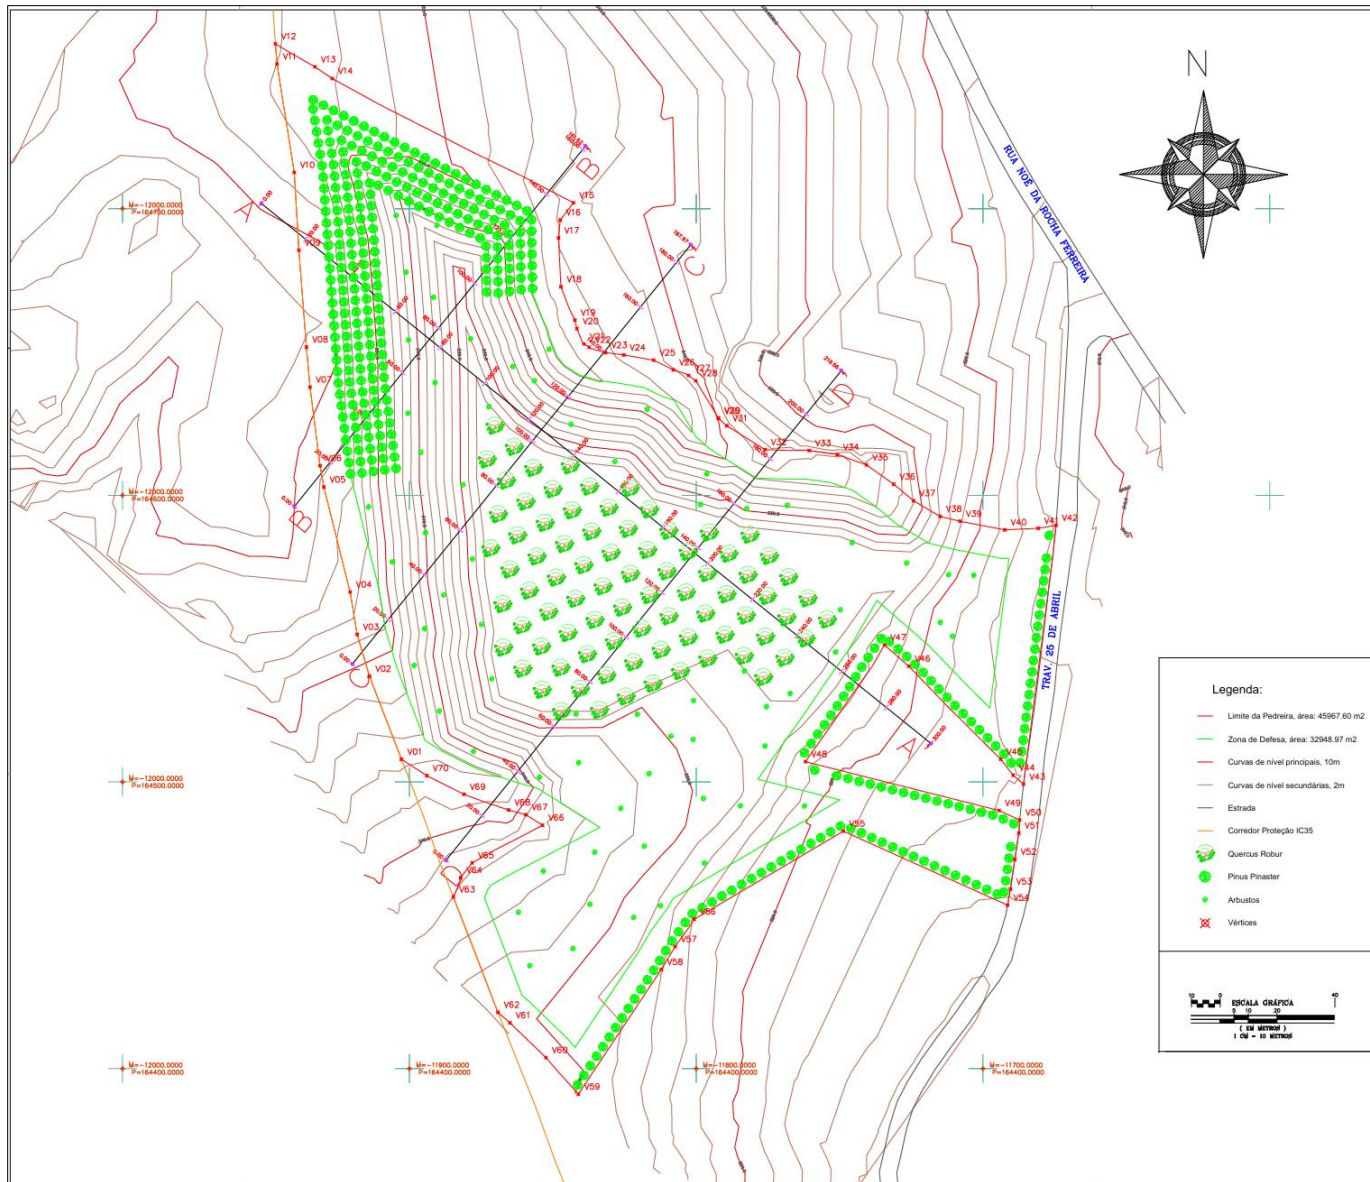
Planta de recuperação paisagística. Fonte: PARP
